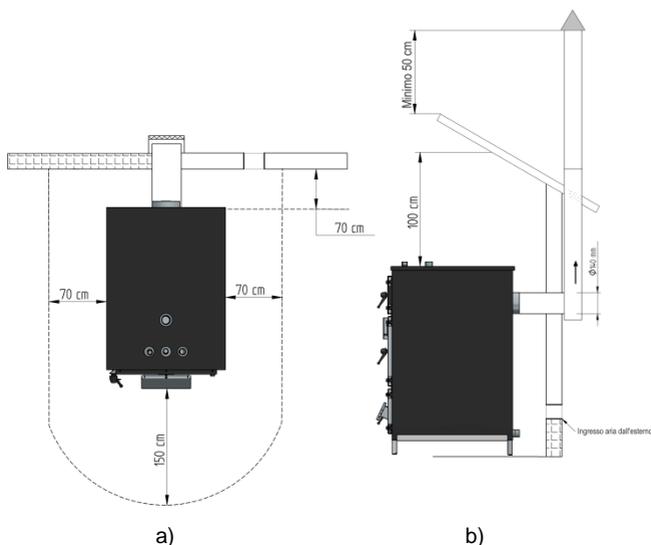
Distanze minime da tutte le superfici: a) vista dall'alto dell'installazione dell'apparecchio; b) vista laterale dell'installazione dell'apparecchio
